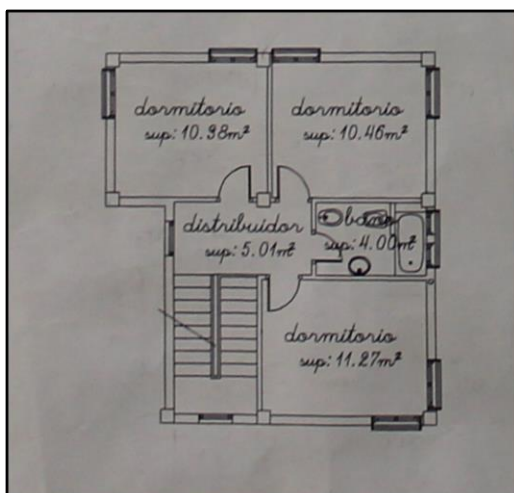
Plano Vivienda conserje Planta Alta Imagen 12. Plano Vivienda conserje planta Baja
